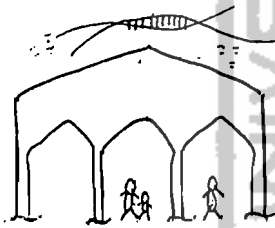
Tonjolan batu yang membentuk hirarki ruang
